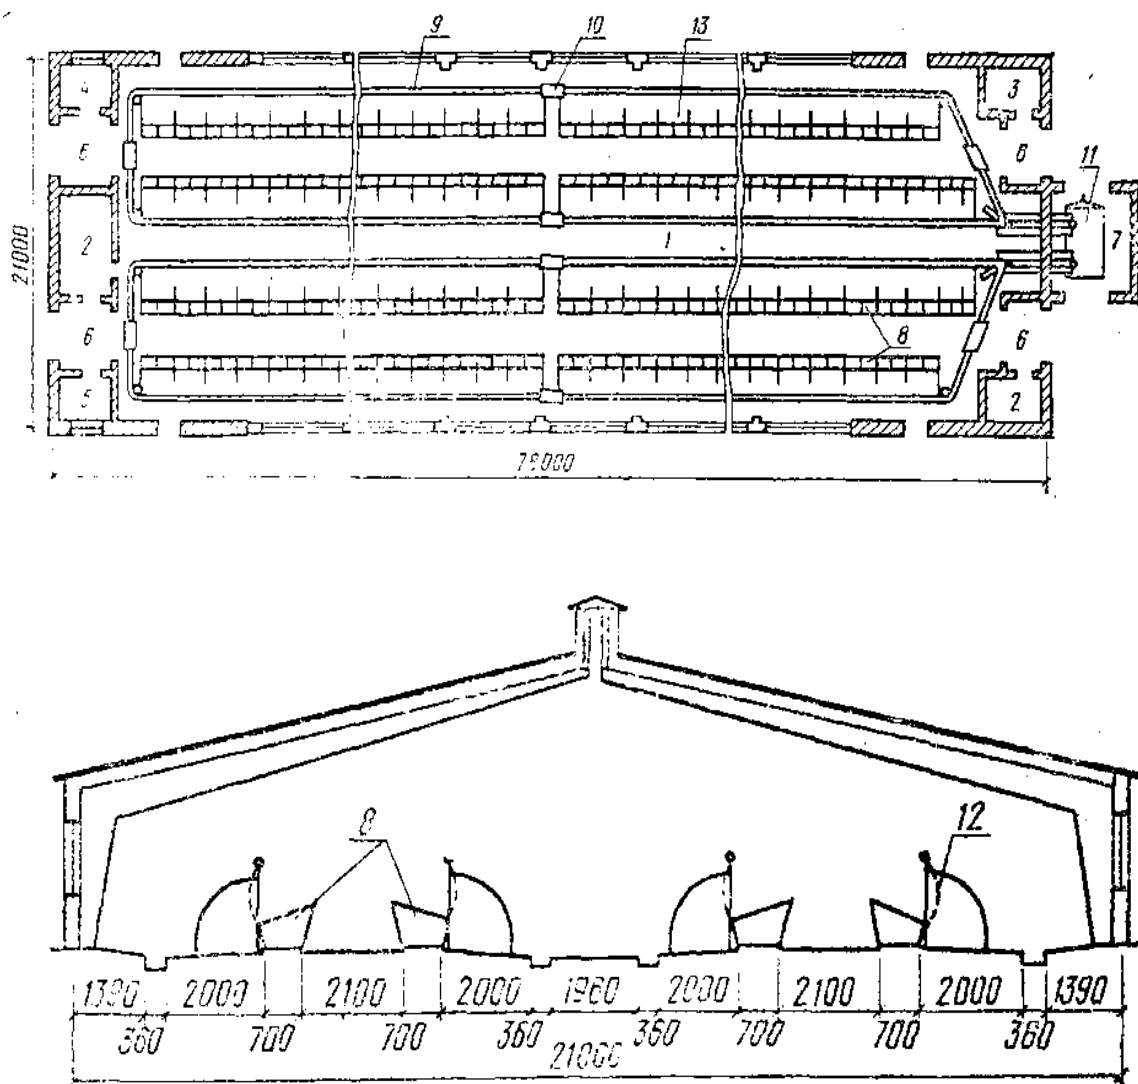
План і розріз будівлі для утримання відгодівельної дорослої худоби на 250 скотомісць:
